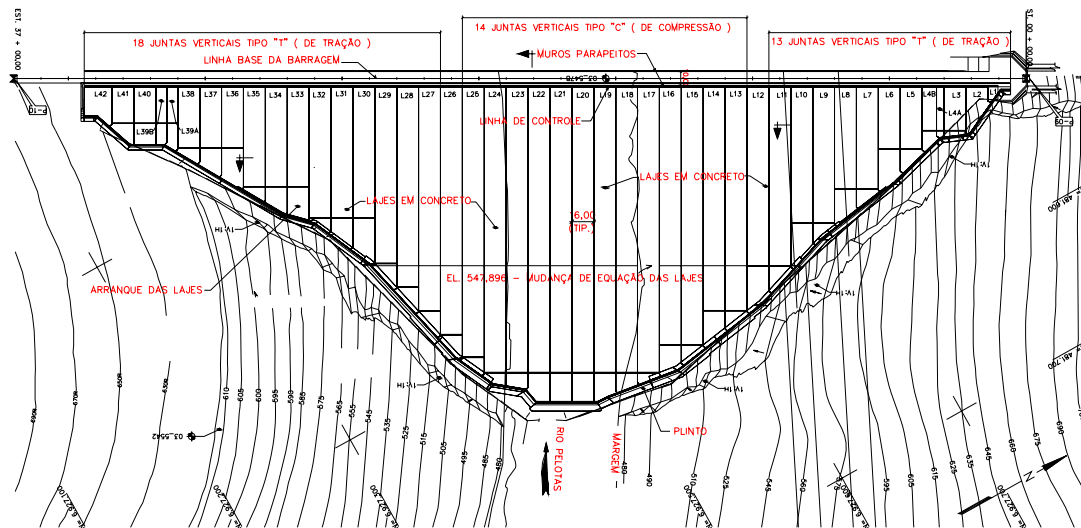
Vista superior à face de concreto (ENGEVIX, 2001).
